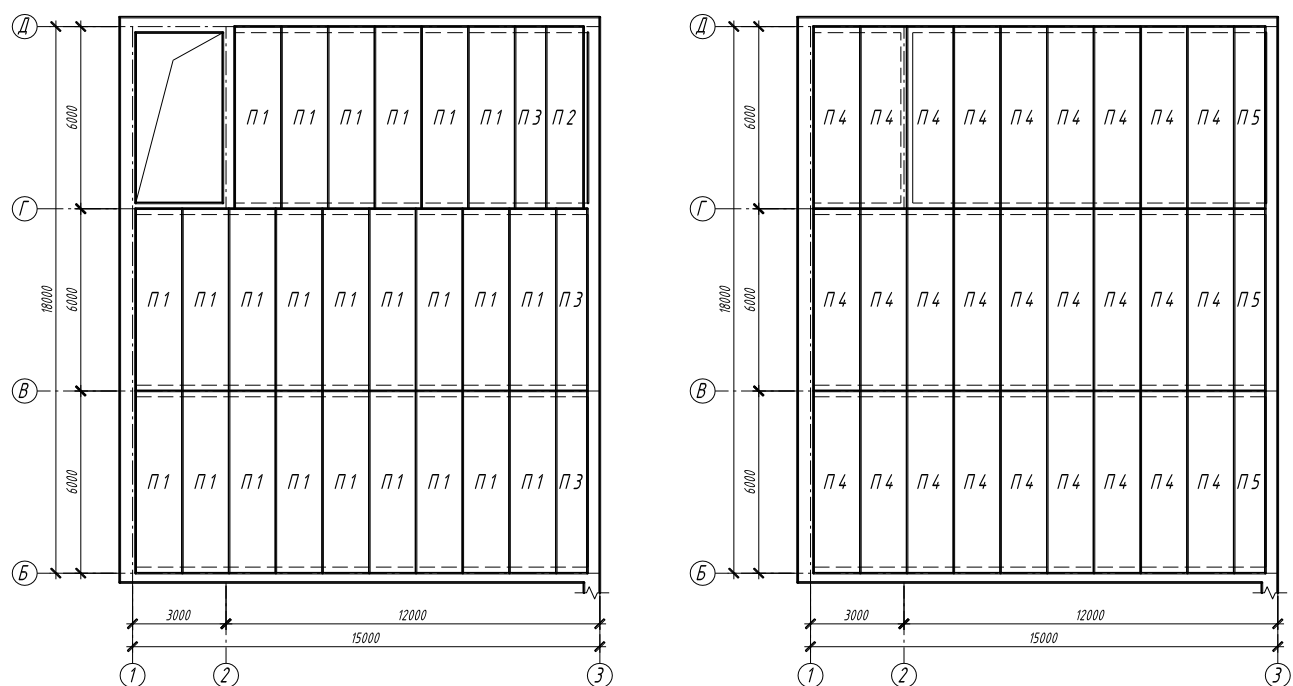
Схеми розташування плит перекриття в осях 1-3
